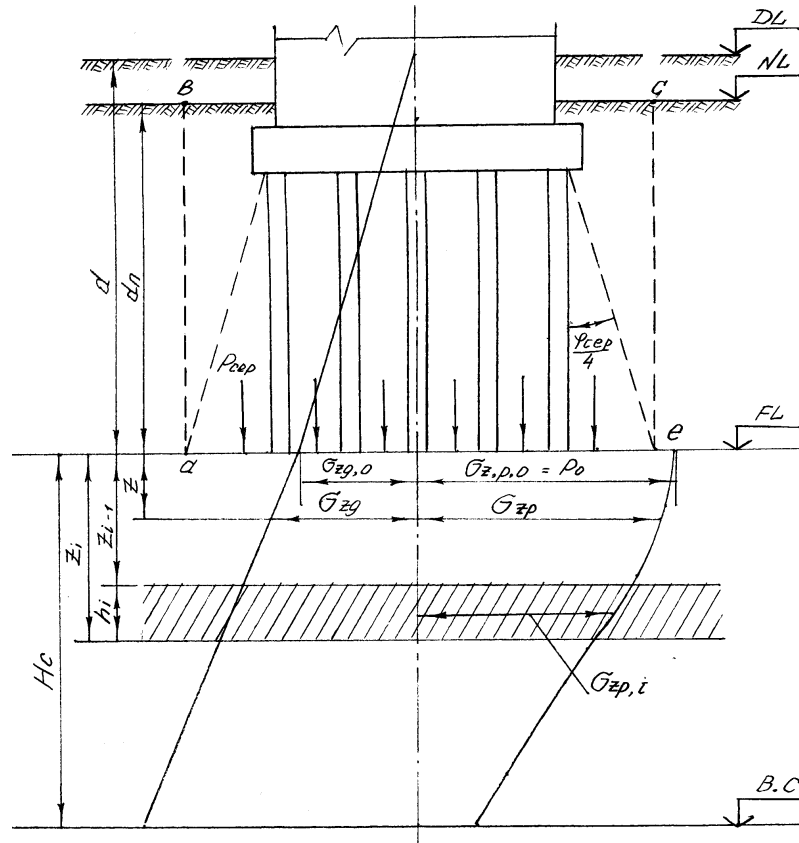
Схема розрахунку осідання пальового фундаменту
